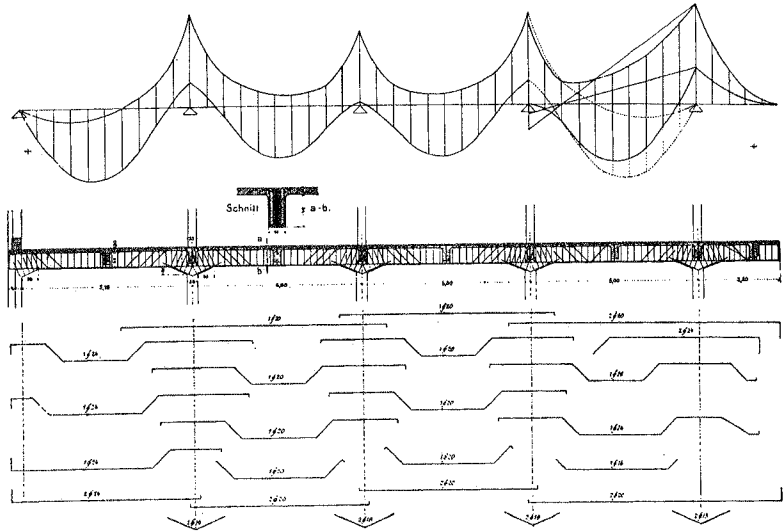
Armierung von Beton: Maximalmomentenlinie und Eiseneinlage (oben) der Hauptträger¹²⁸⁰⁾
